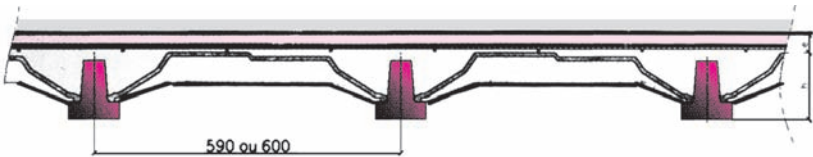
Schéma d'ensemble de la construction des semelles, du soubassement et du plancher par l'entreprise du gros œuvre
